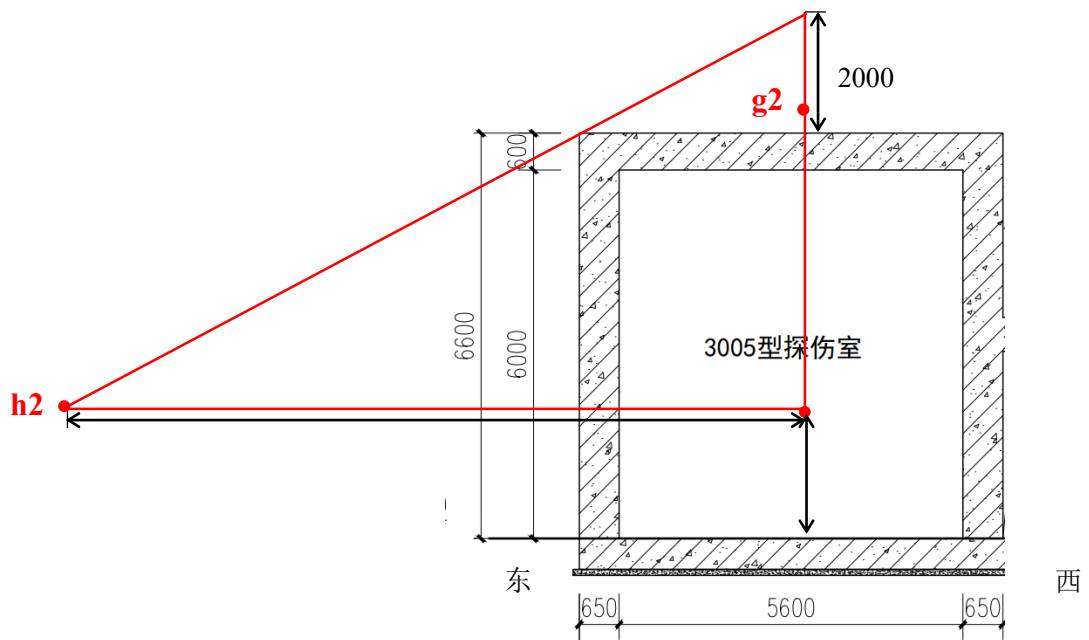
2号探伤室辐射屏蔽计算预测点位剖面图 (单位: mm)
